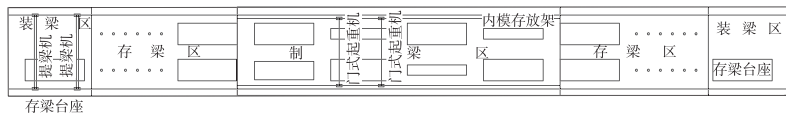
提梁机搬梁、运梁车经运梁通道出梁箱梁预制场平面布置图
